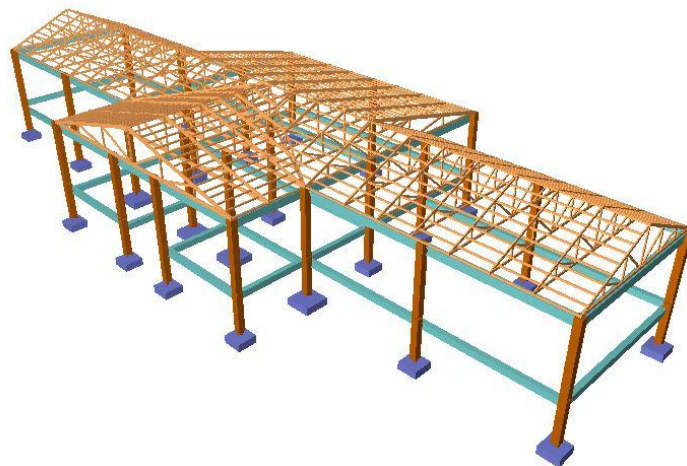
Vista 3D de la cubierta del Bloque Laboratorios
